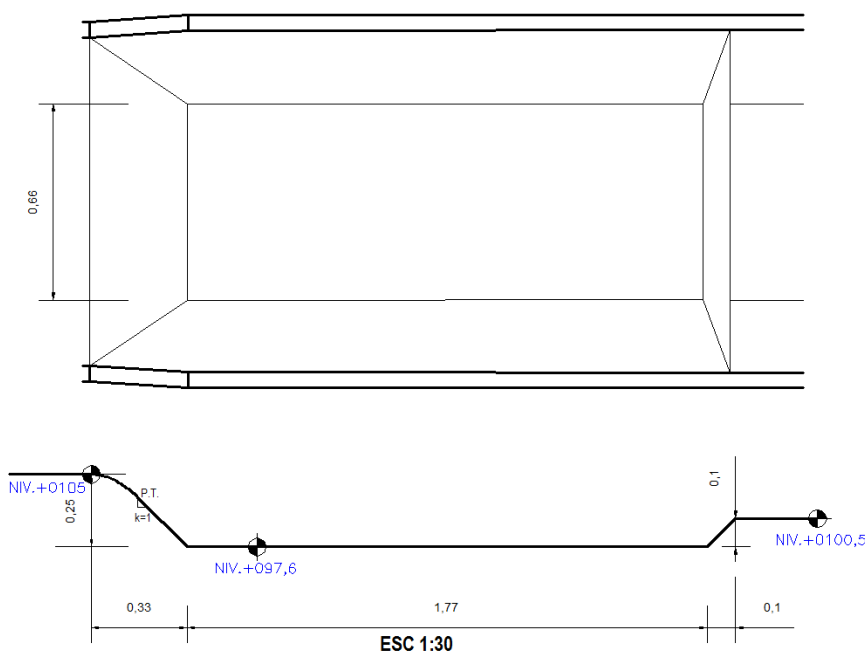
Perfil y planta del modelo físico (acotaciones, en metros)
